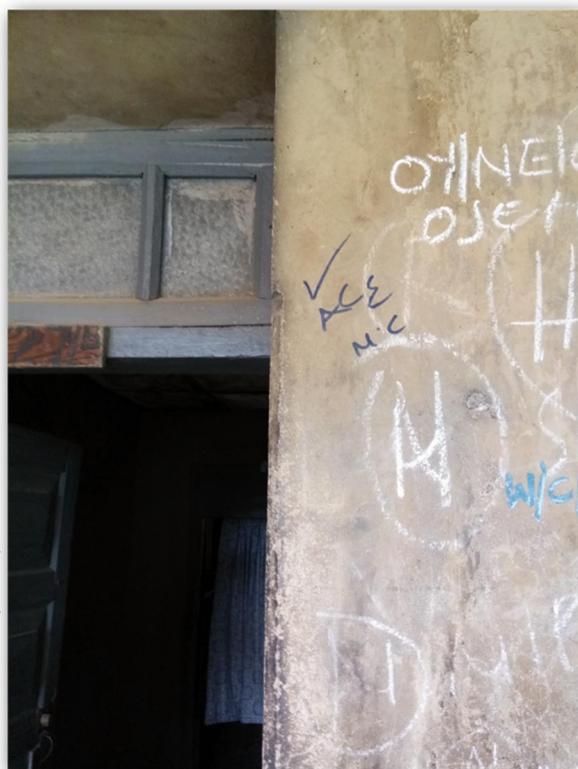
FAÇADE MARQUÉE D'UN « NC » POUR NOT CONNECTED (NON CONNECTÉ)
